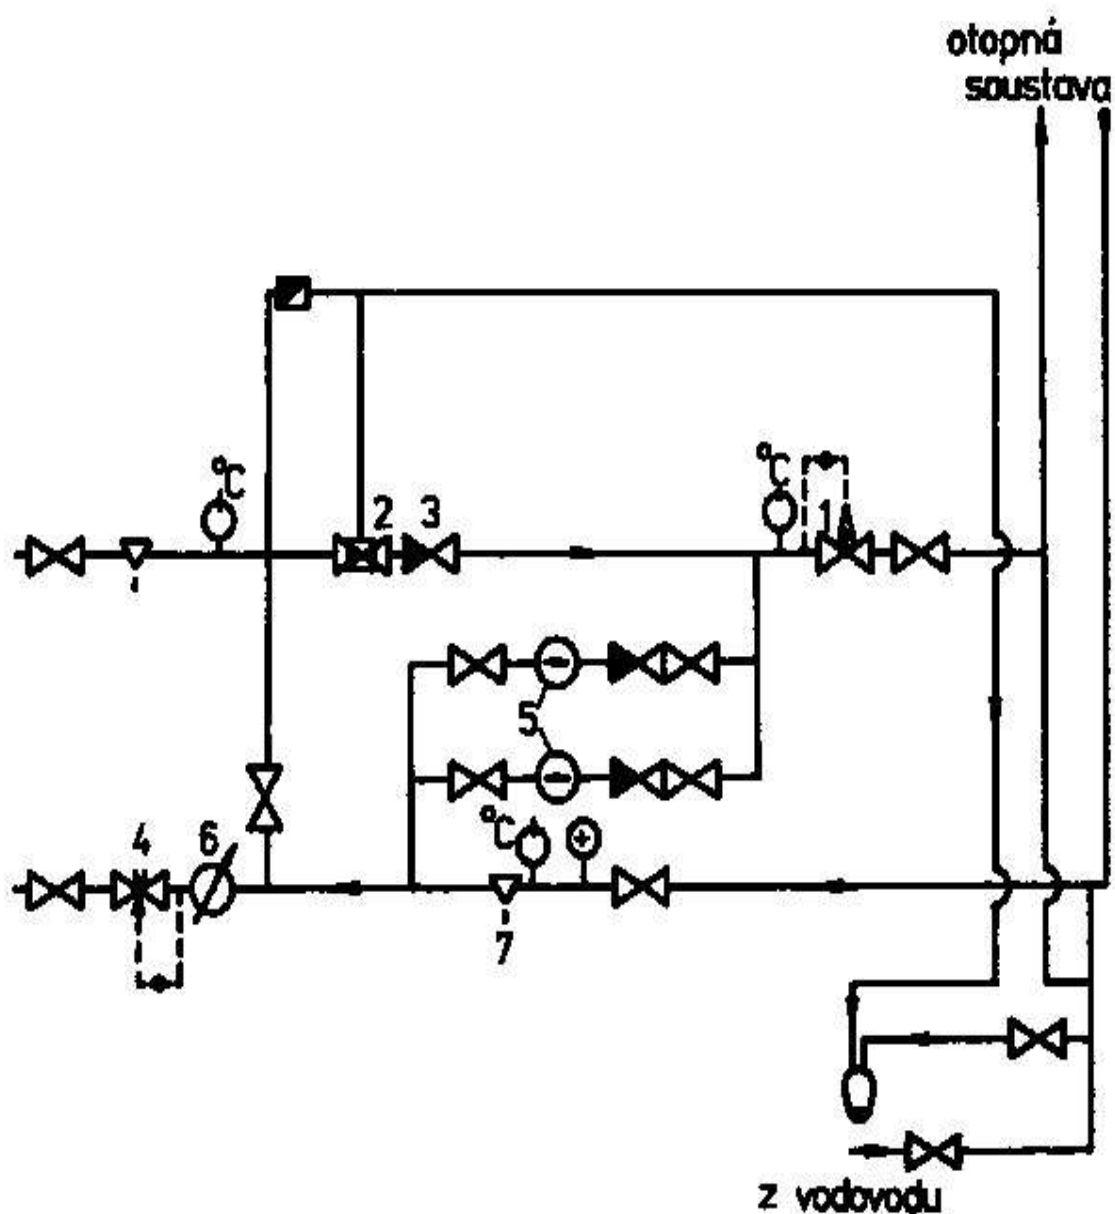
Jednoduchý hydraulický okruh se škrcením
